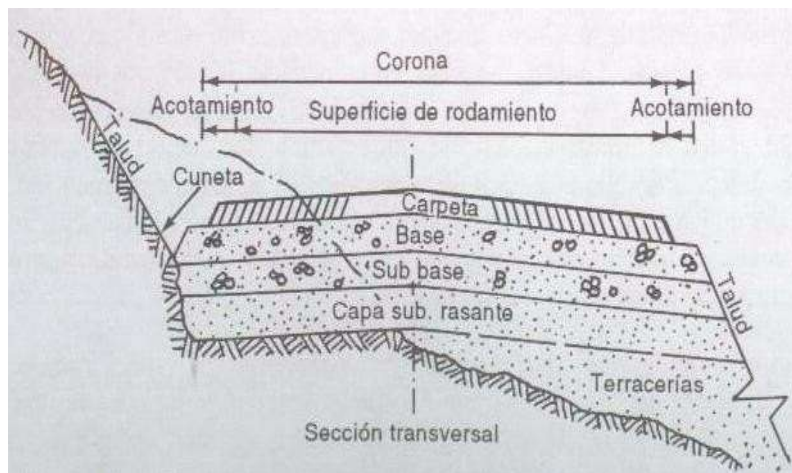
Sección transversal típica de un pavimento flexible en una sección en balcón.
